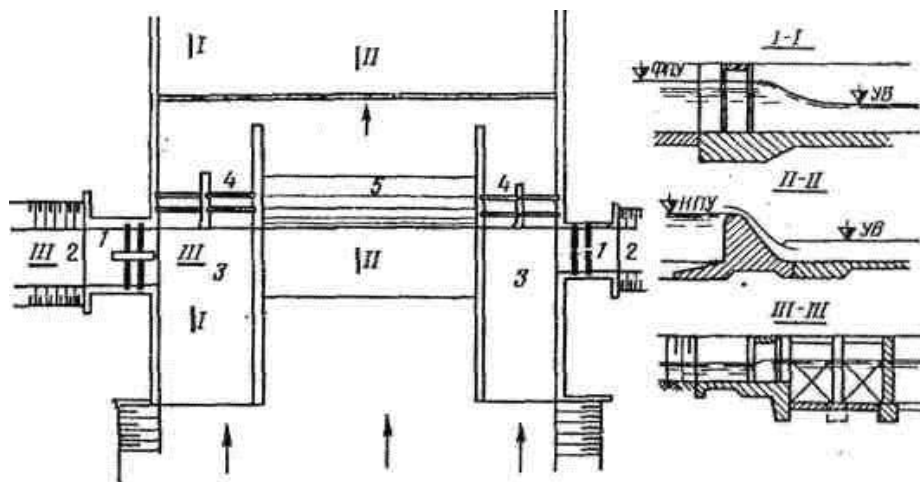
Фронтальный водозабор с карманами-отстойниками:
